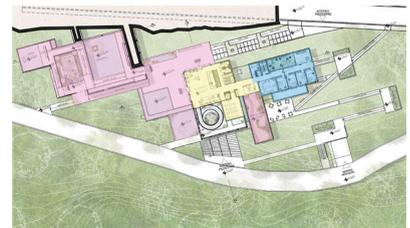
Figura X: Planta Baixa Superior | Fonte: Arq. Vinicius Breda
